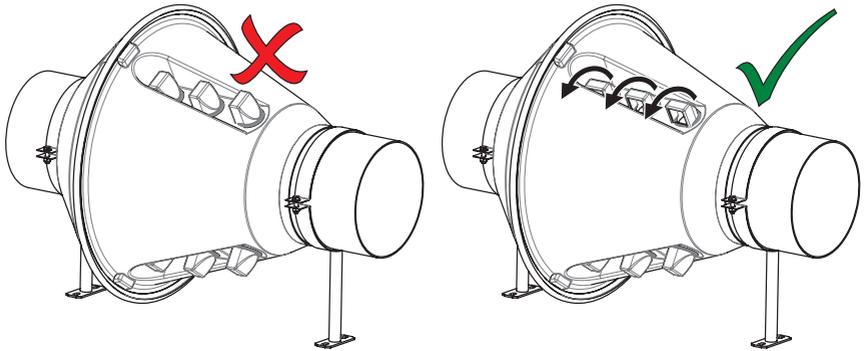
Orienter la manchette d'air en cas d'installation extérieure en position horizontale
